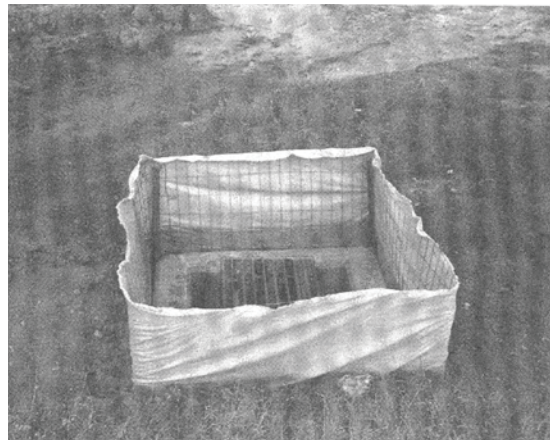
DRENADO POR FILTRADO CON GEOTEXTIL HACIA REGISTRO
